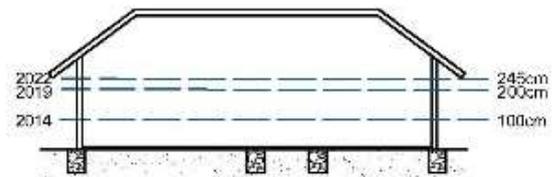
Denah Rumah Bapak Sanadi Setelah Rekonstruksi
